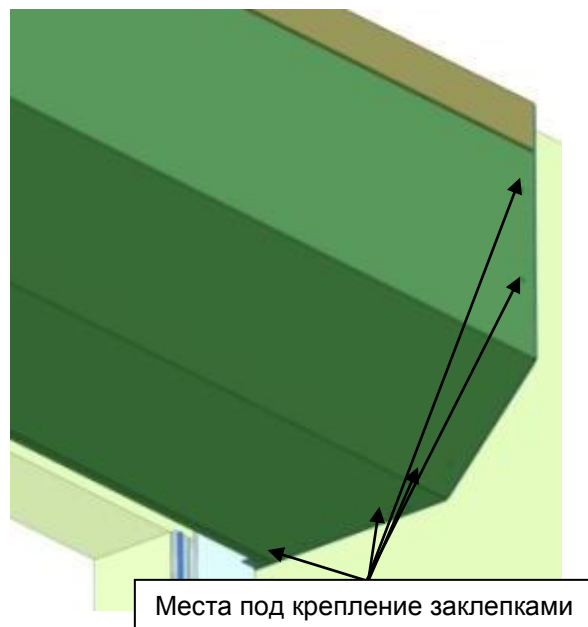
Засверловка отверстий в крышках и коробе
